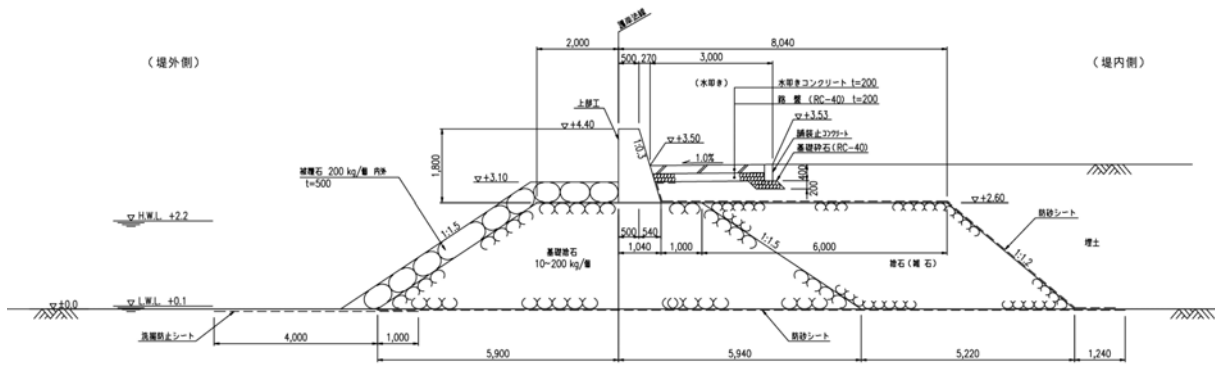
辺野古地先水面作業ヤードの護岸断面図
